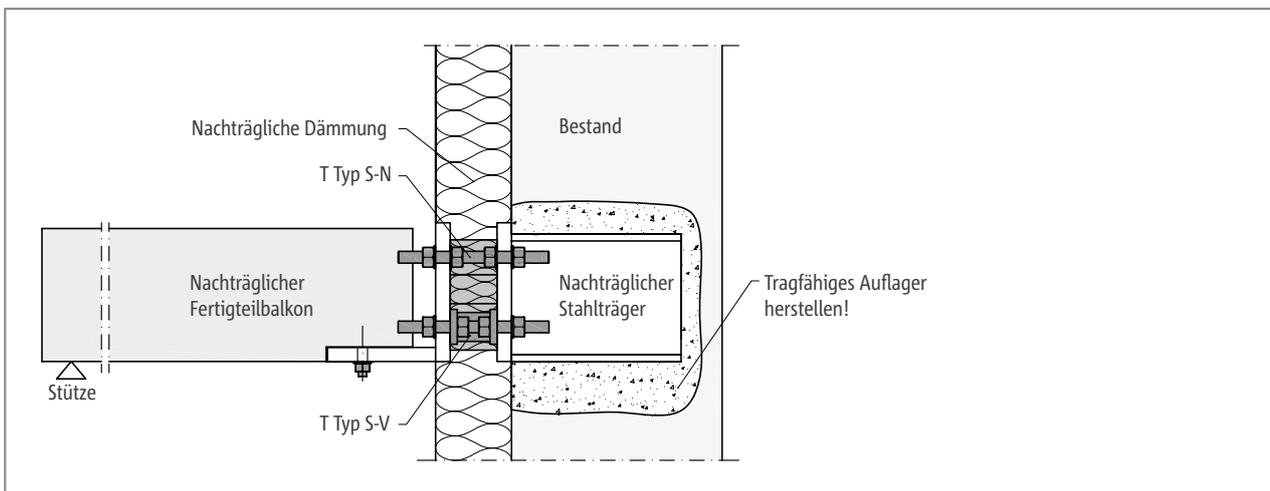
Schöck Isokorb® T Typ S-N und T Typ S-V: Nachträglicher Fertigteilbalkon gestützt; angeschlossen an nachträglich eingebauten Stahlträger mit Wechsel
